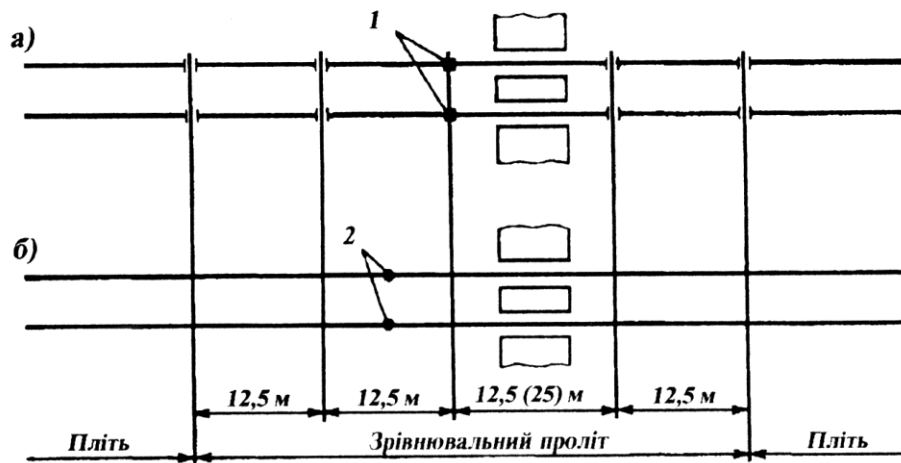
Схема зрівнювального прольоту на переїзді:
